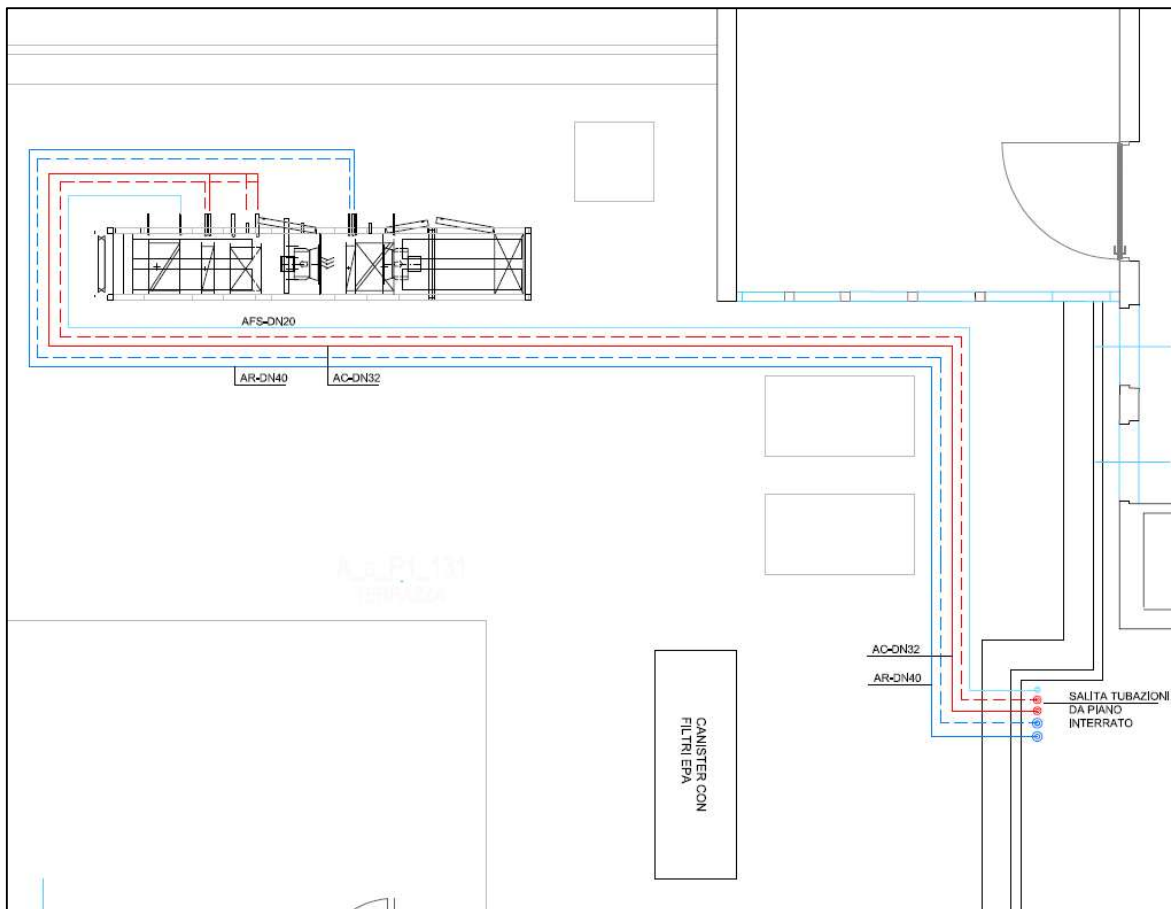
Planimetria terrazzo di copertura al piano primo - Progetto
